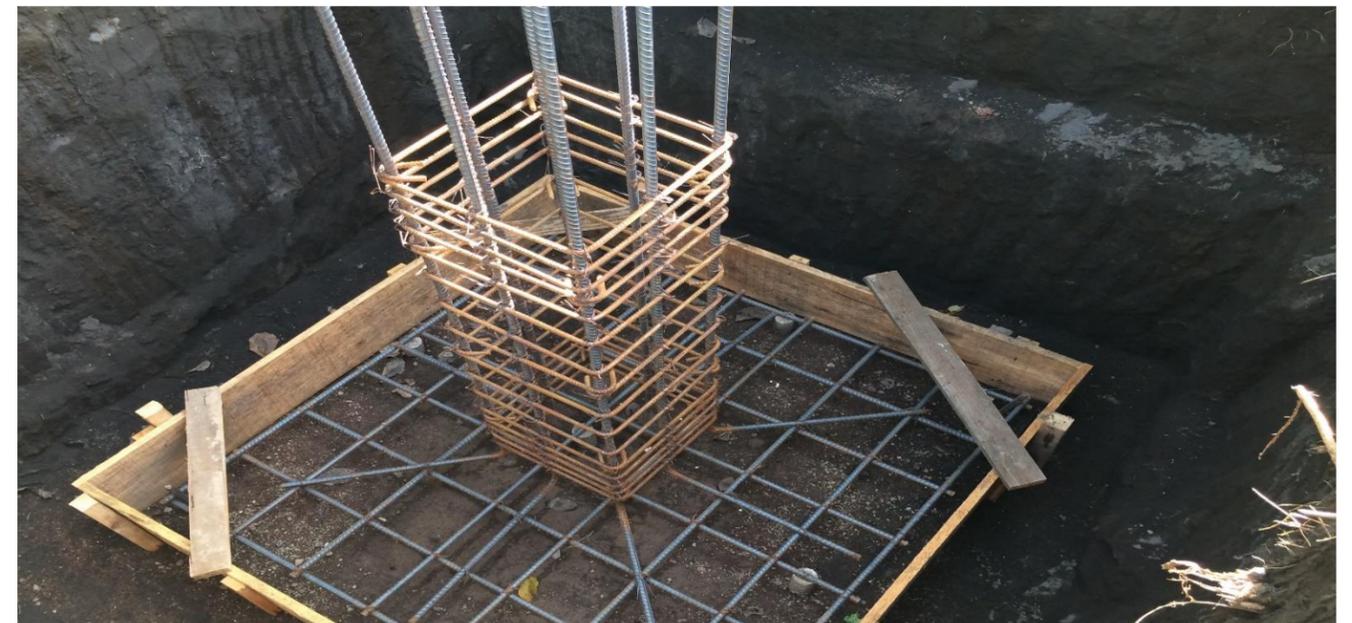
Armado de hierro. Encofrado de zapatas. Fuente: Autor.
